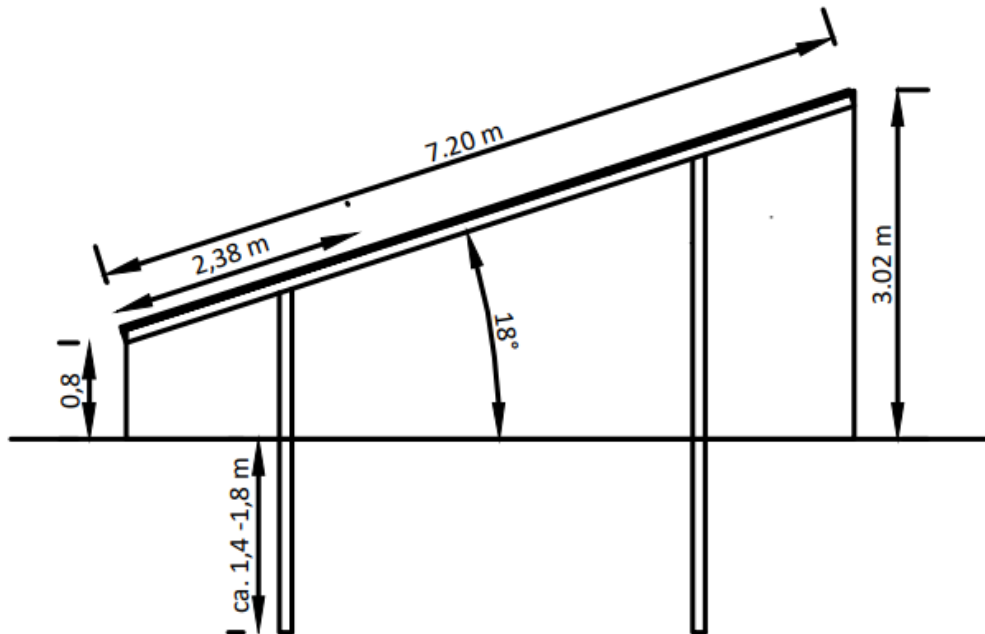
Technische Zeichnung - Quelle: Auftraggeber
